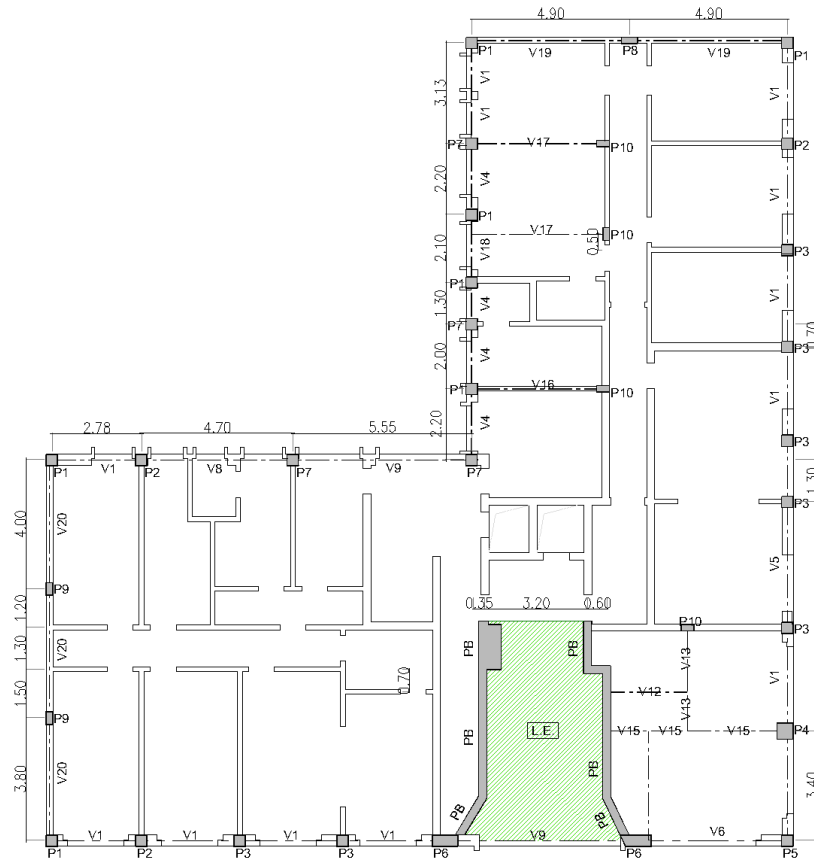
Planta de estabilidade da Cave (Piso Térreo)
